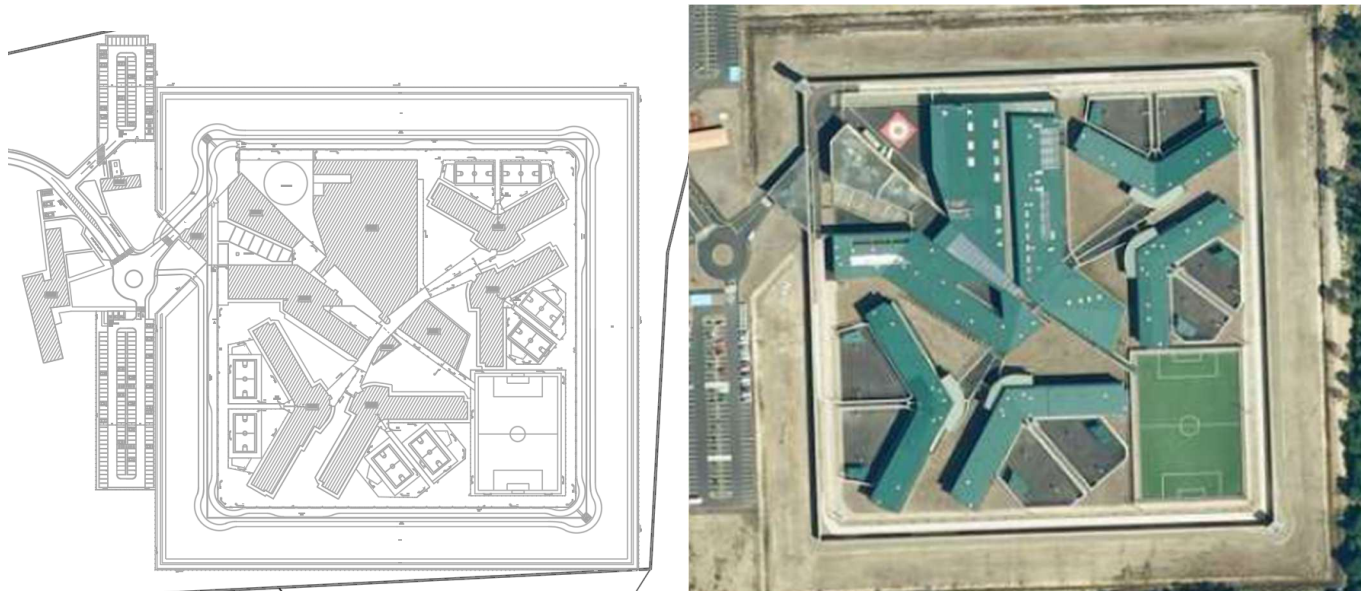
Plan masse/vue aérienne de la prison (DOE, GEO FONDATION)
